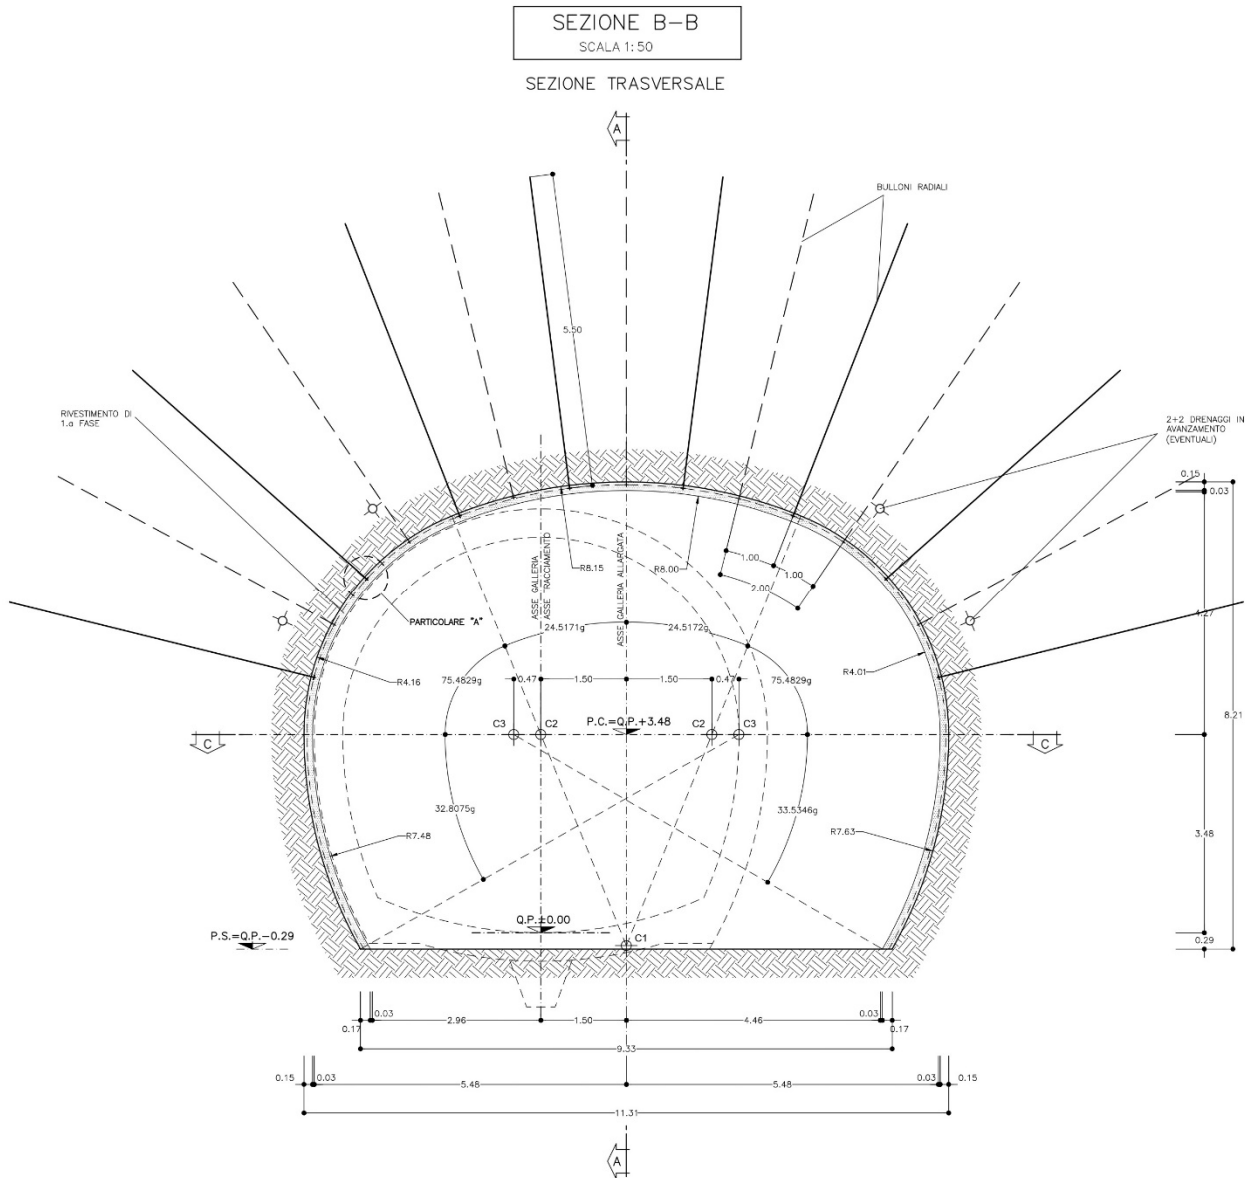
Sezione Tipo Ab “Allargata” – Scavi e consolidamenti - Sezione
